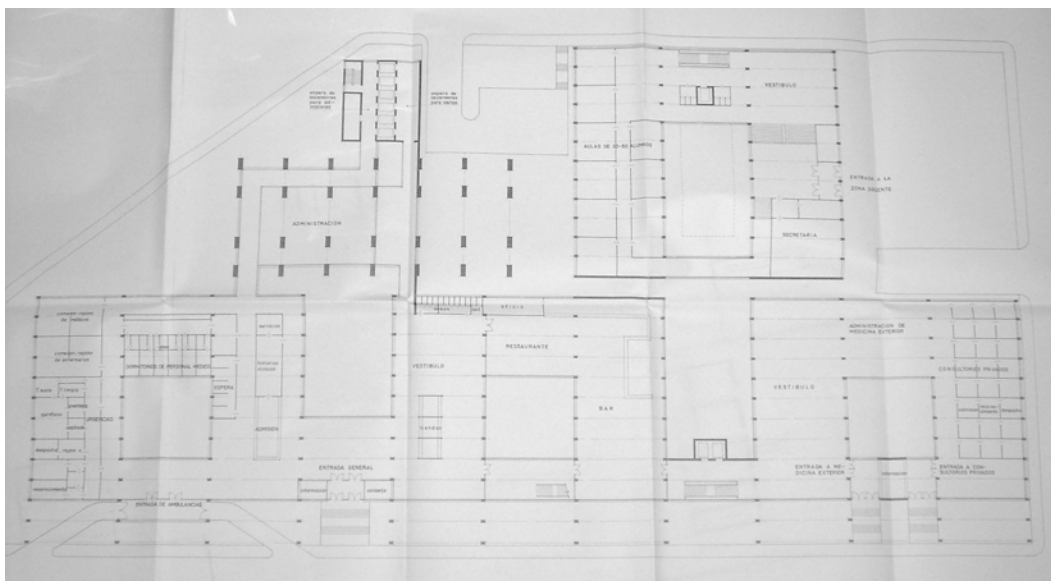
Anteproyecto de Hospital Clínico: planta baja, por Giráldez, López y Subías, 1967.
